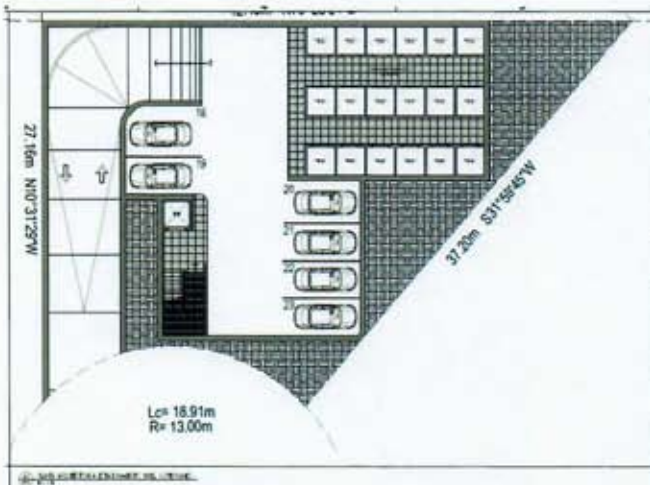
Planta arquitectónica nivel subterráneo.⁹⁹
